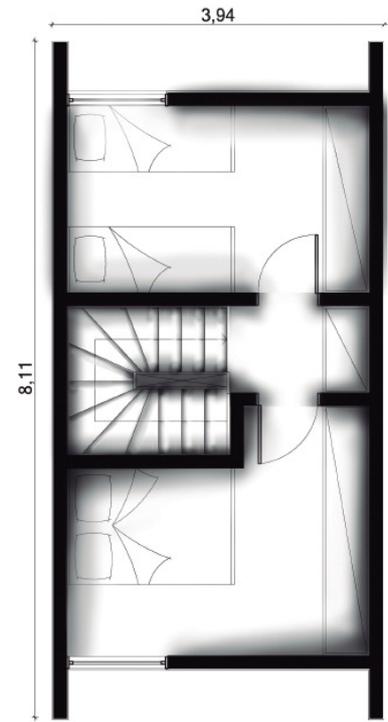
Planta-baixa do primeiro pavimento.
